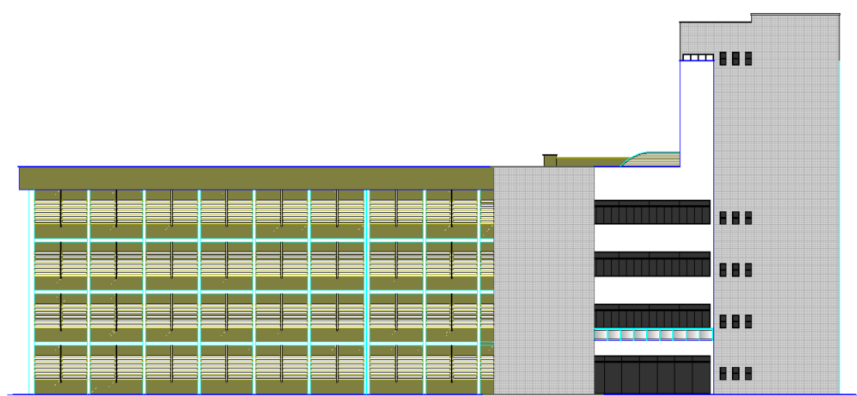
Imagem projeto arquitetônico fachada Norte em Autocad.
